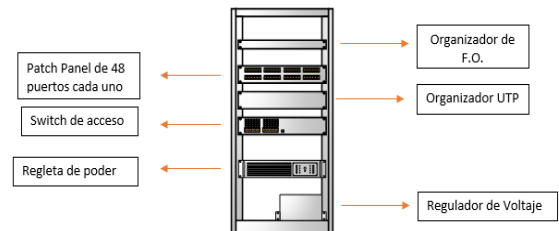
Distribución de equipos en Rack de Cuarta Planta
